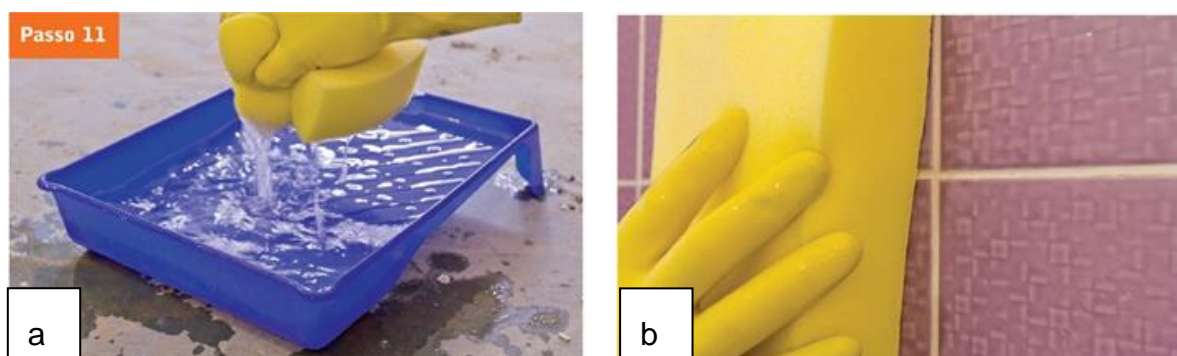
Aplicação da argamassa (foto a) e retirado do excesso de argamassa da superfície da cerâmica (foto b).
